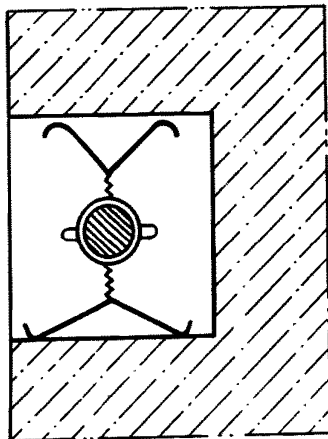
Установка арматуры с помощью проволочного фиксатора
